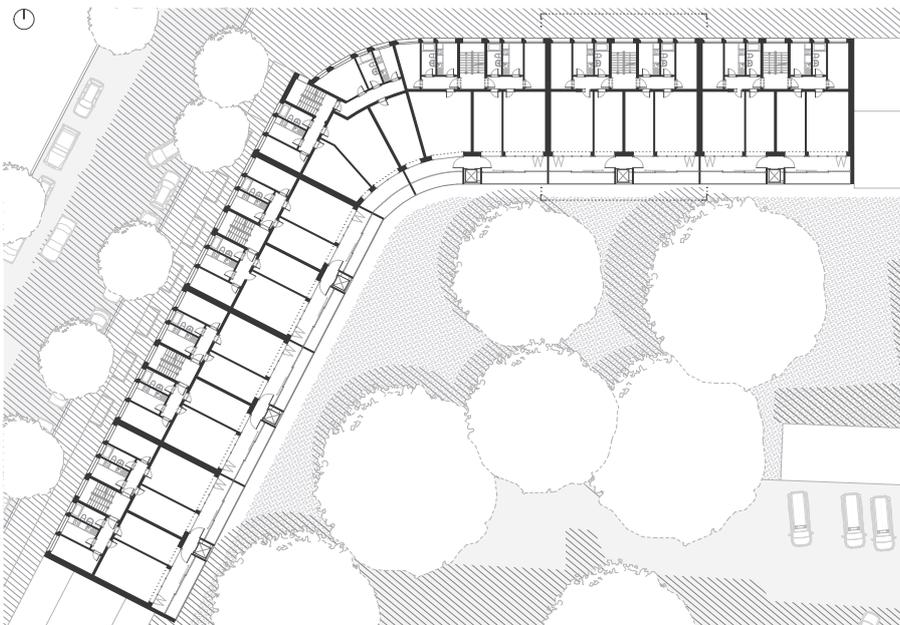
Grundriss des Bestands, 1. bis
